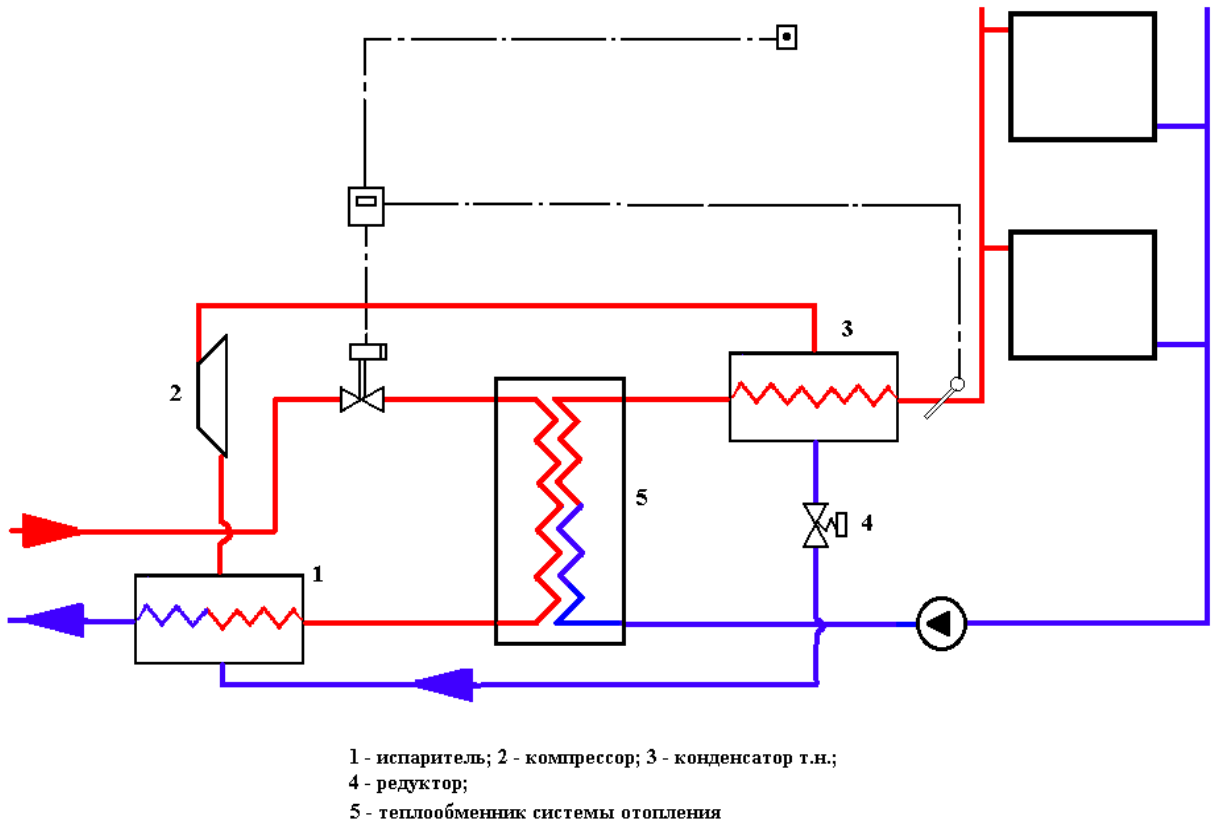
Схема теплового пункта с тепловым насосом с конденсатором на подающем трубопроводе системы отопления
